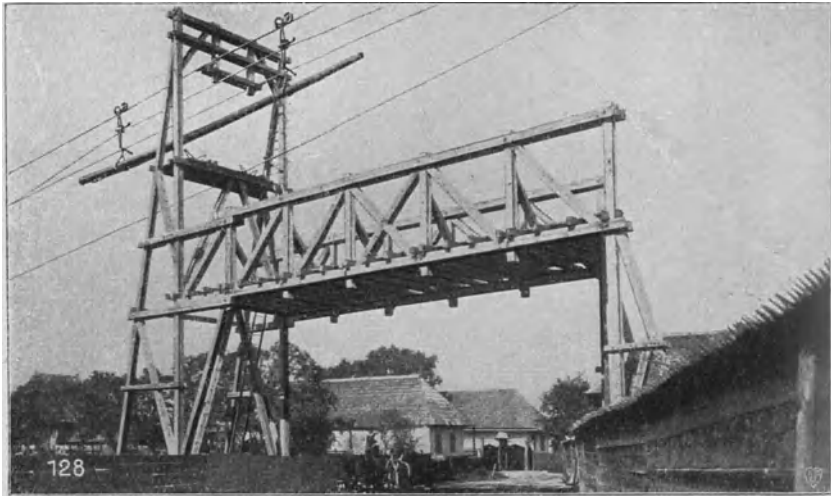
Hölzerne Schutzbrücke mit Stütze (Kaiser & Co.).
